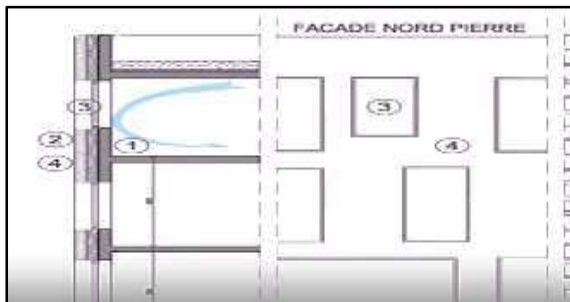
coupe schématique de la façade nord. Source : www.archdaily.com
